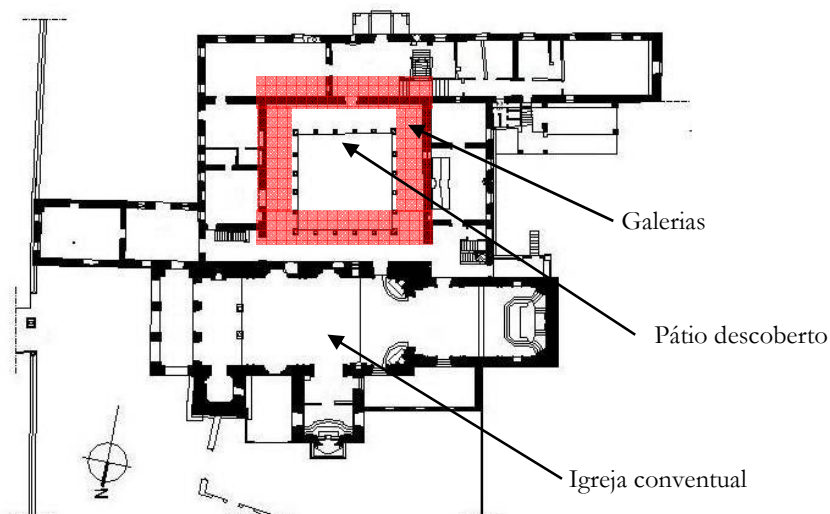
Convento de Santo Antônio, Ipojuca, Pernambuco – Planta do pavimento térreo.
